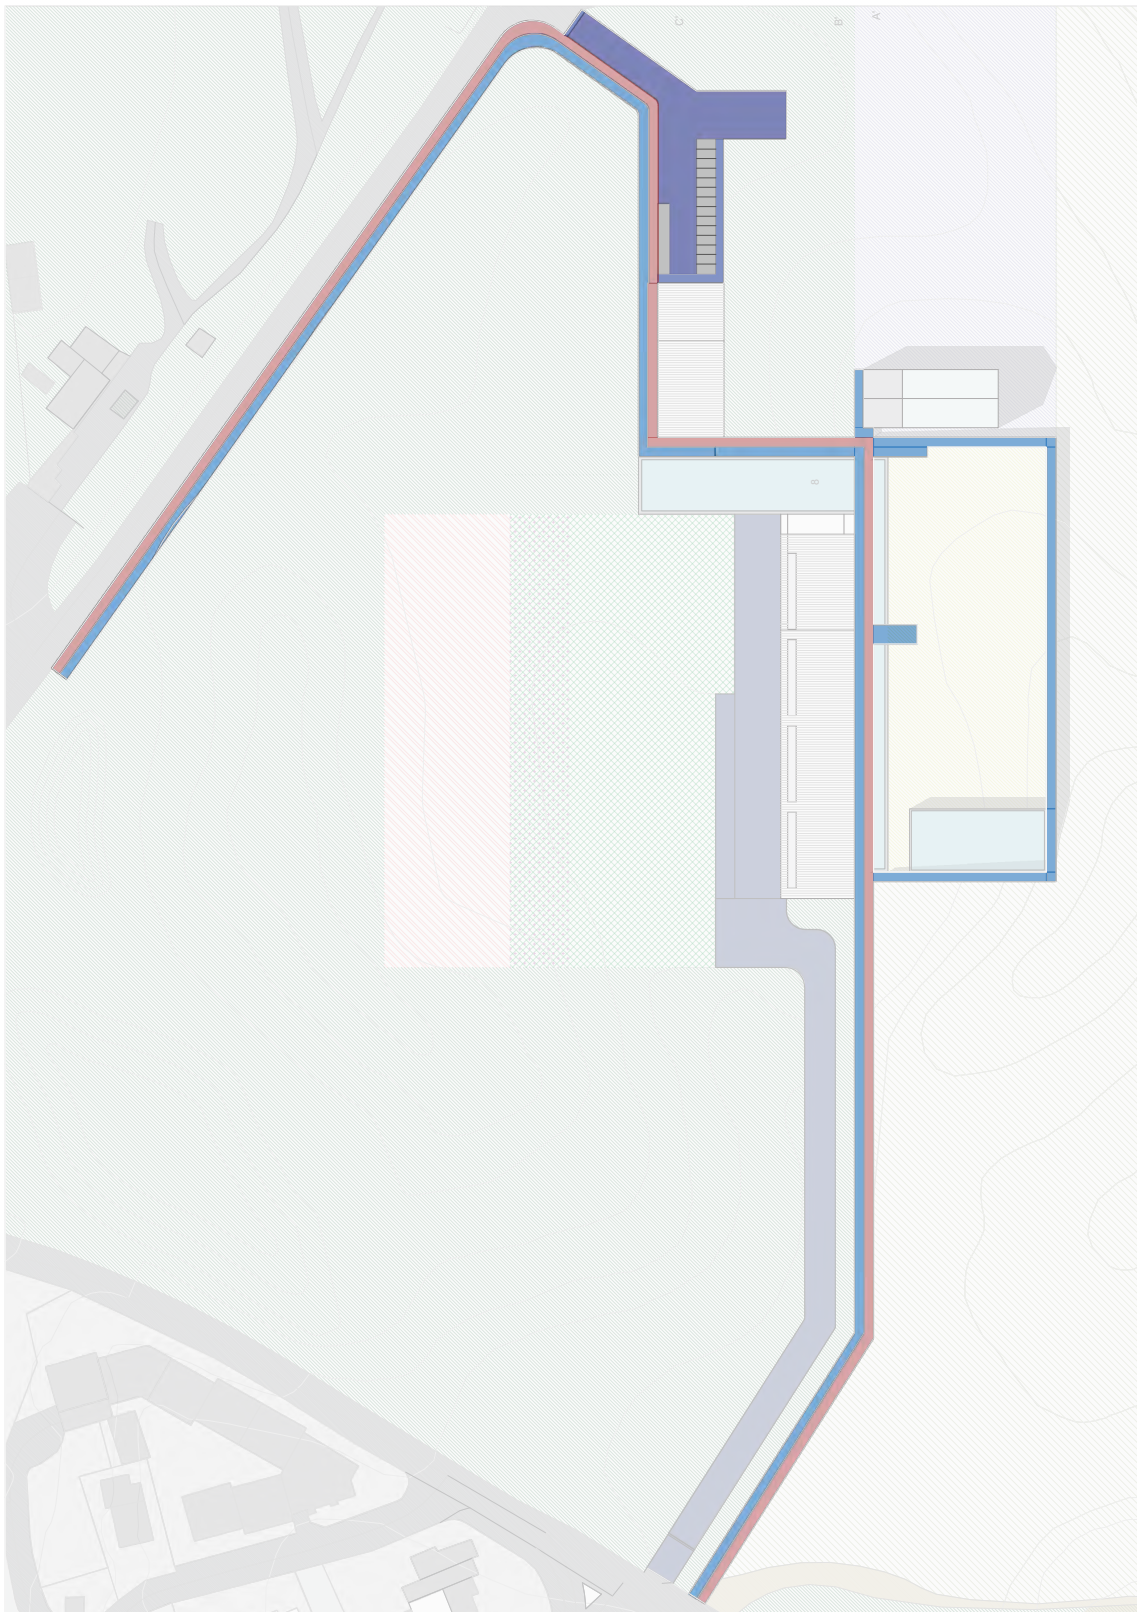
Planta da Proposta de Intervenção com a indicação dos percursos, sem escala.
